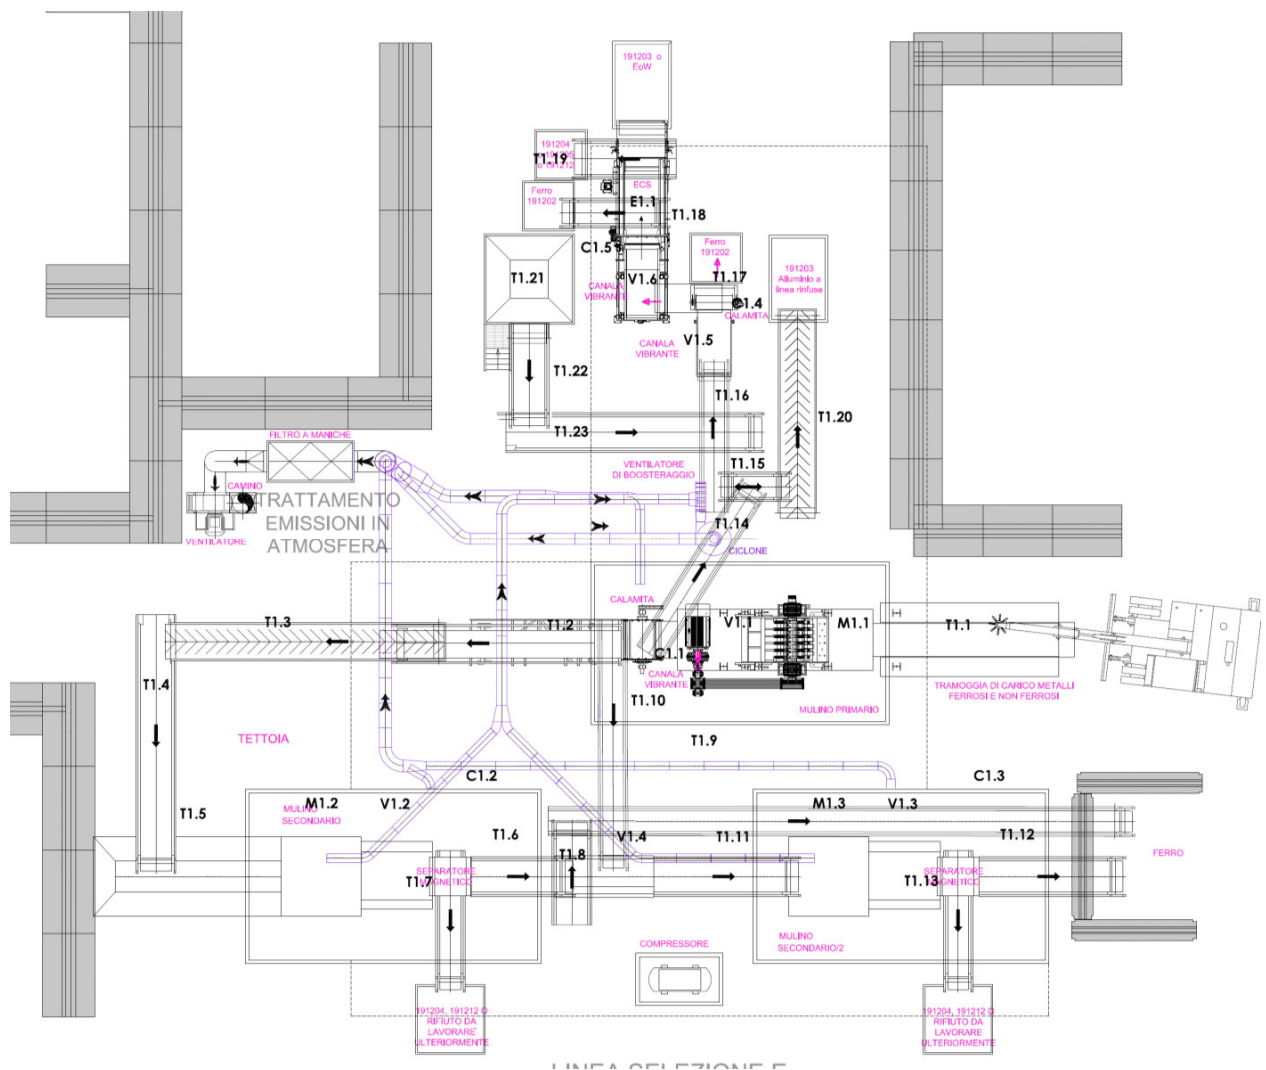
layout della linea A+B (estratto tav. 7.1)
